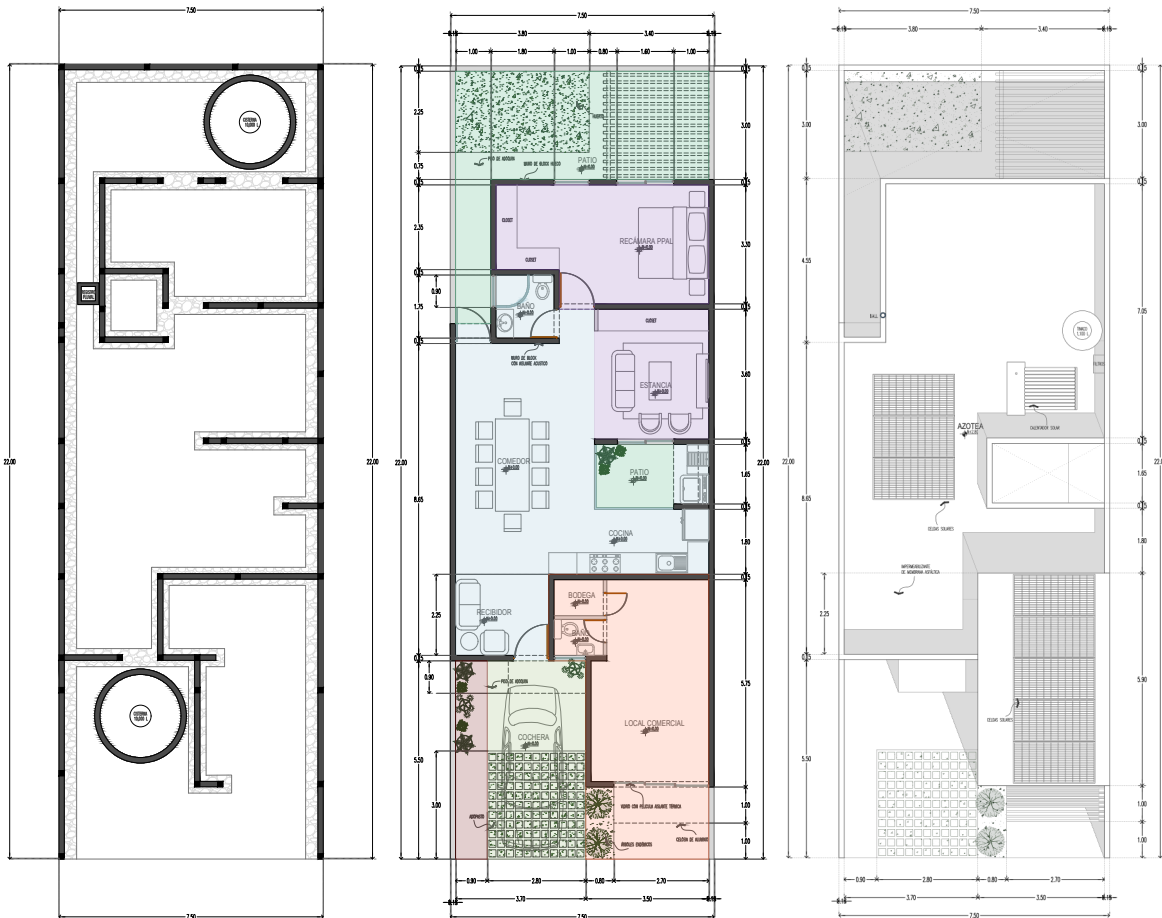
Planta de cimentación, planta baja y planta alta de etapa 3a.
